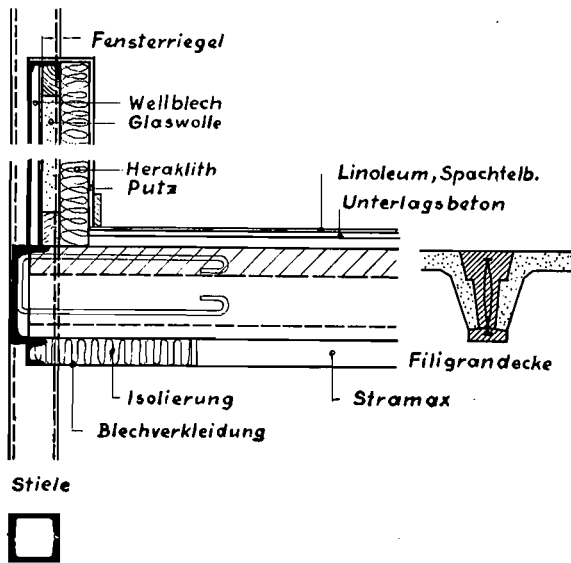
Wanddetail, Neues Bürohaus der Fa. Waldmann & Bruder, Wien
